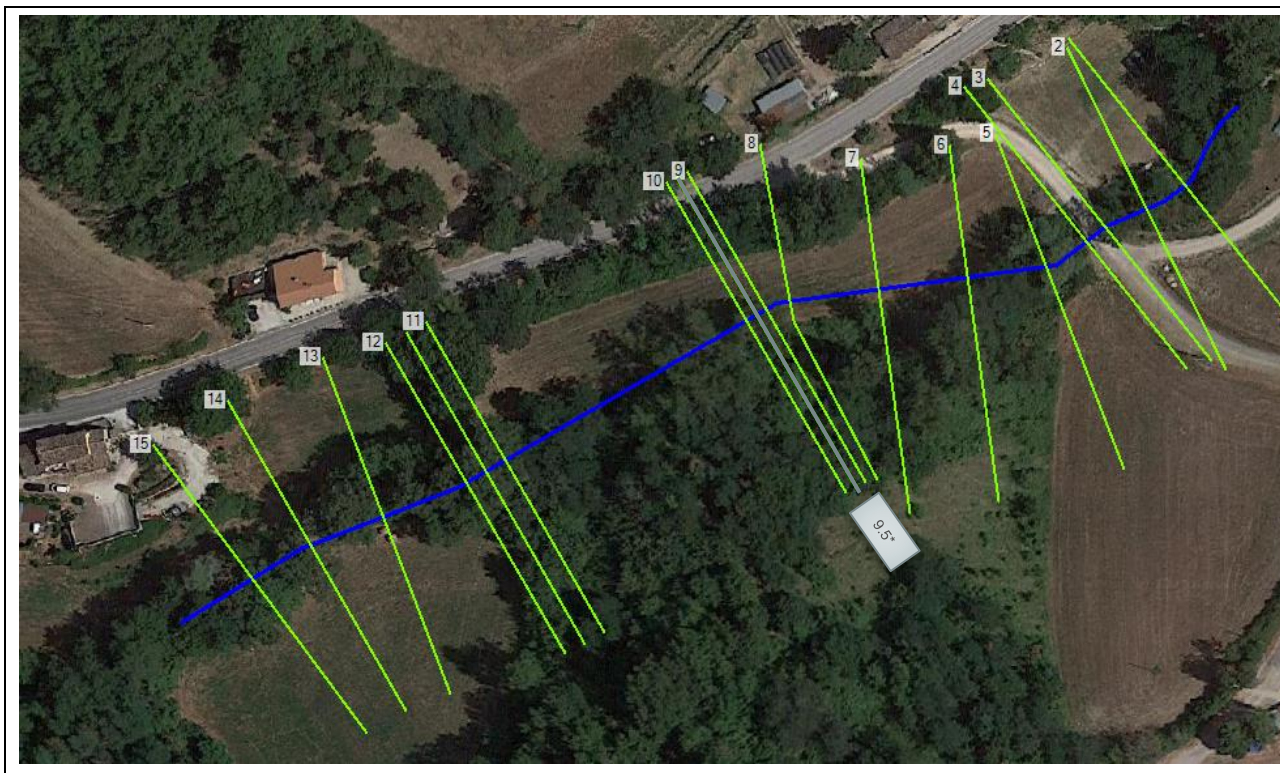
Fosso Chienti- inquadramento Planimetrico su ortofoto delle sezioni di modellazione
